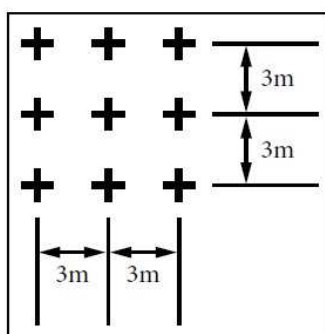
Verificação da propriedade E, grelha de 3 metros (Concrete Society, 2014).
